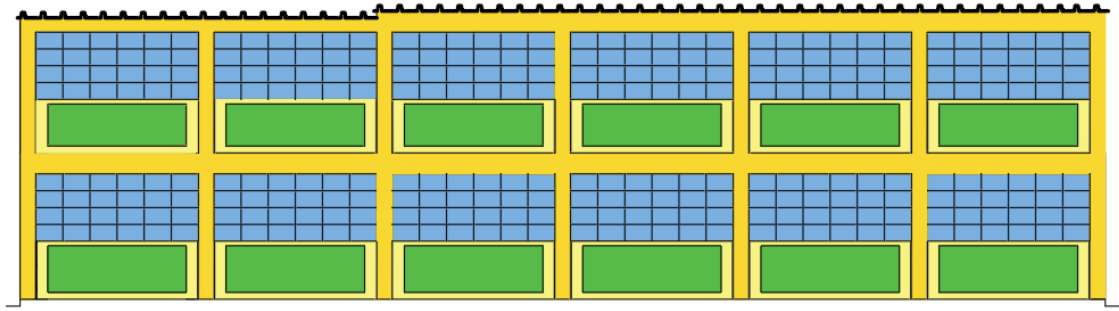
Elevación posterior del pabellón 7. Fuente: Elaboración propia.
